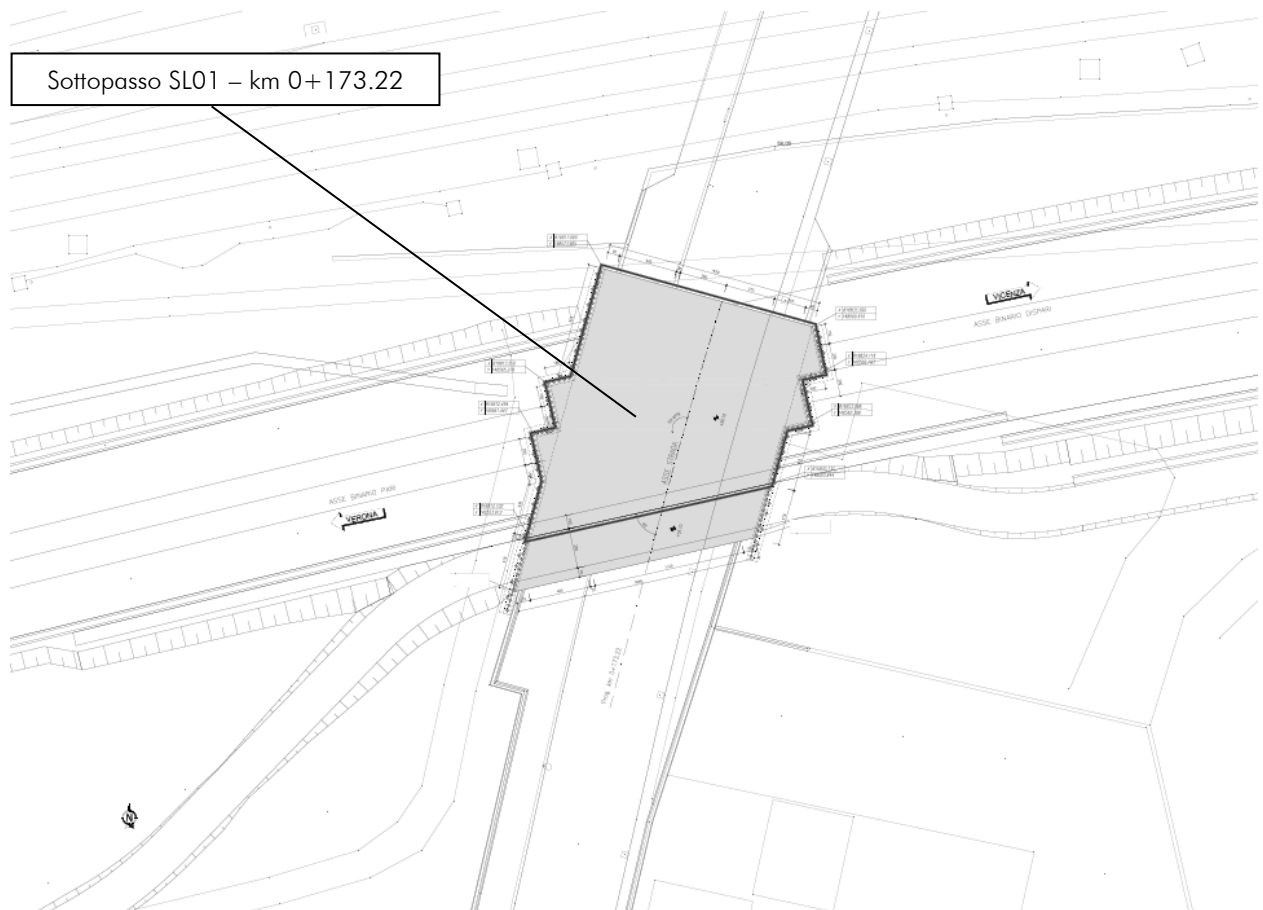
Stralcio planimetrico – Ubicazione Sottovia SL01
